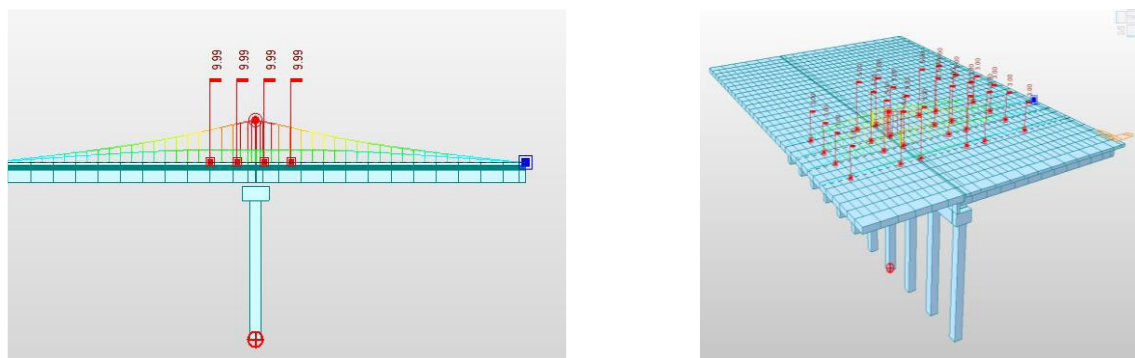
Расчетная схема нагружения испытательной нагрузкой крайней опоры
